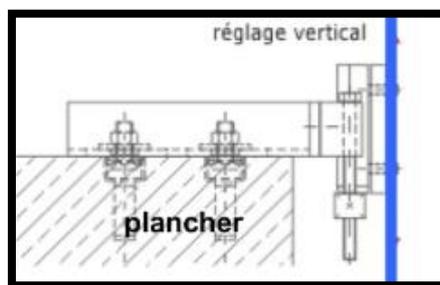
fixation d'un mur rideau sur plancher<sup>227</sup>
